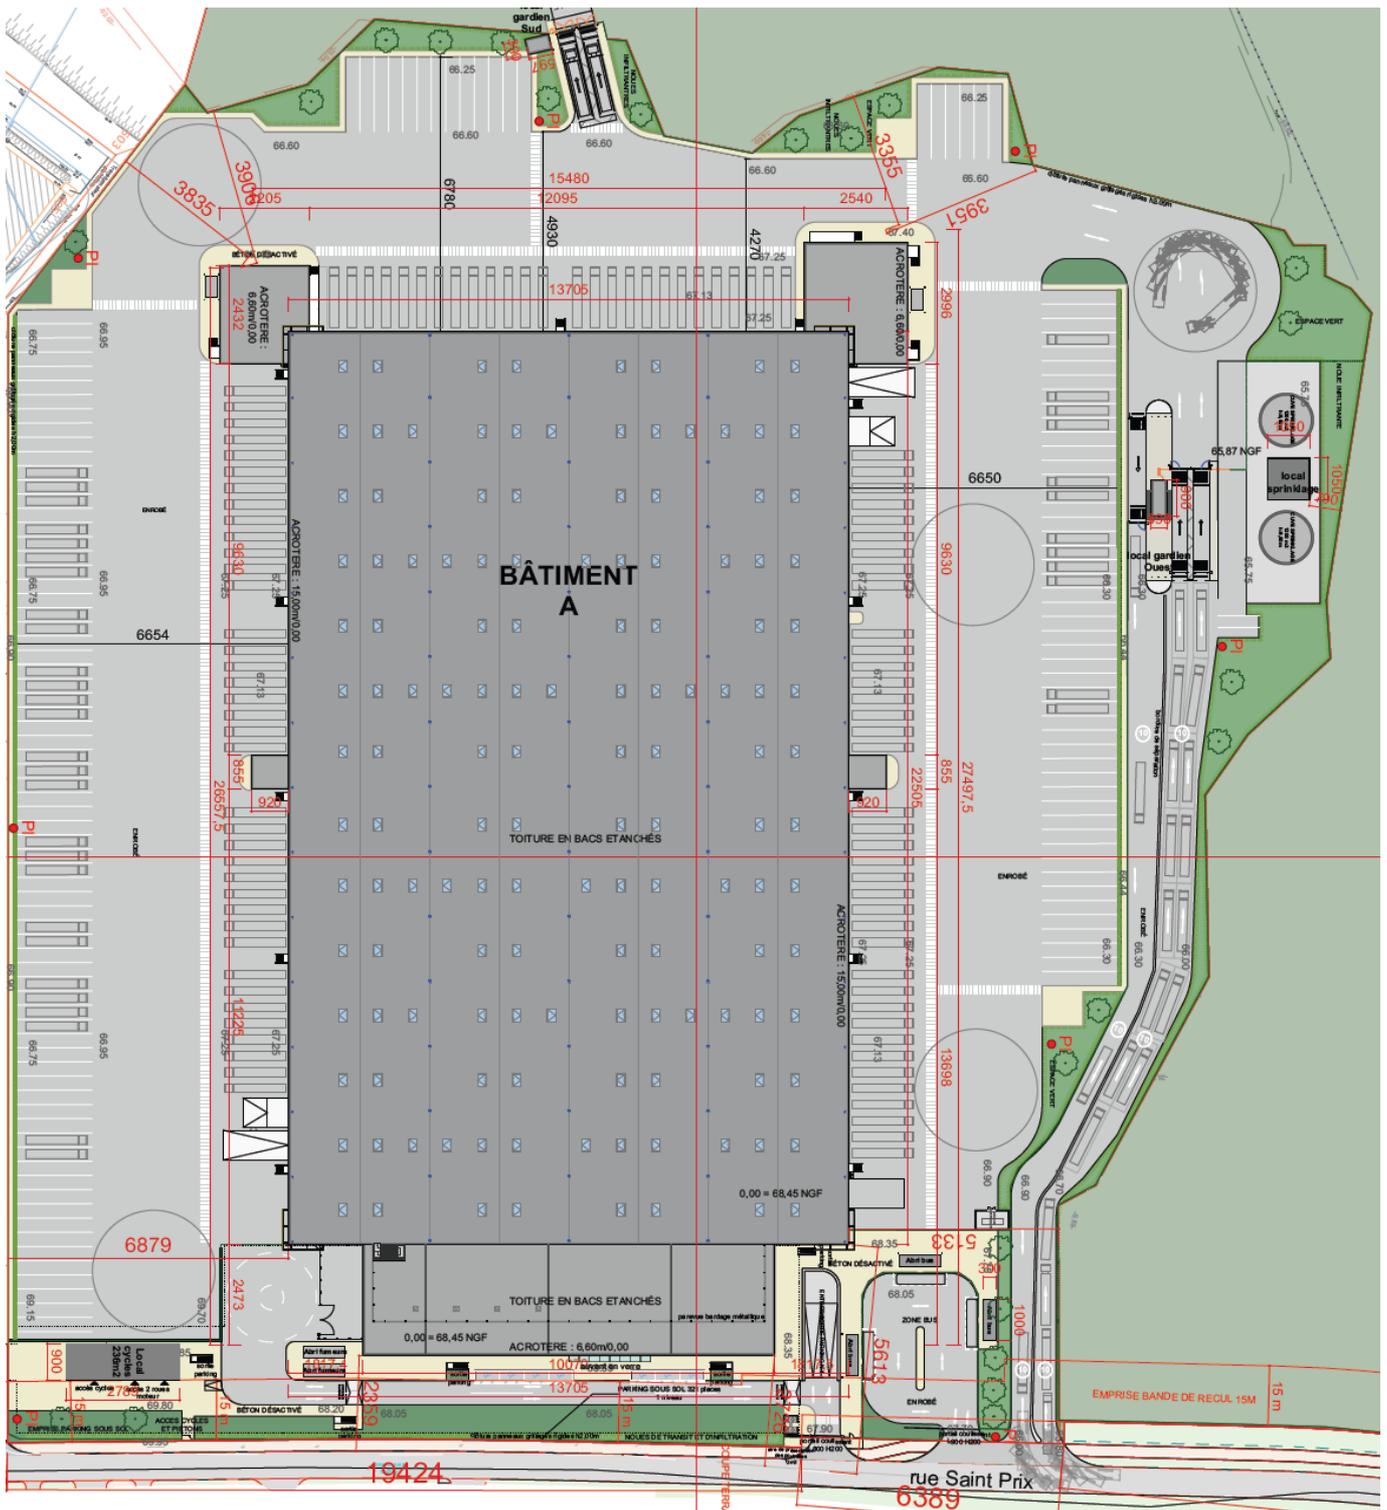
plan de masse - lot A - (source : volet « plans » du dossier de permis de construire)
